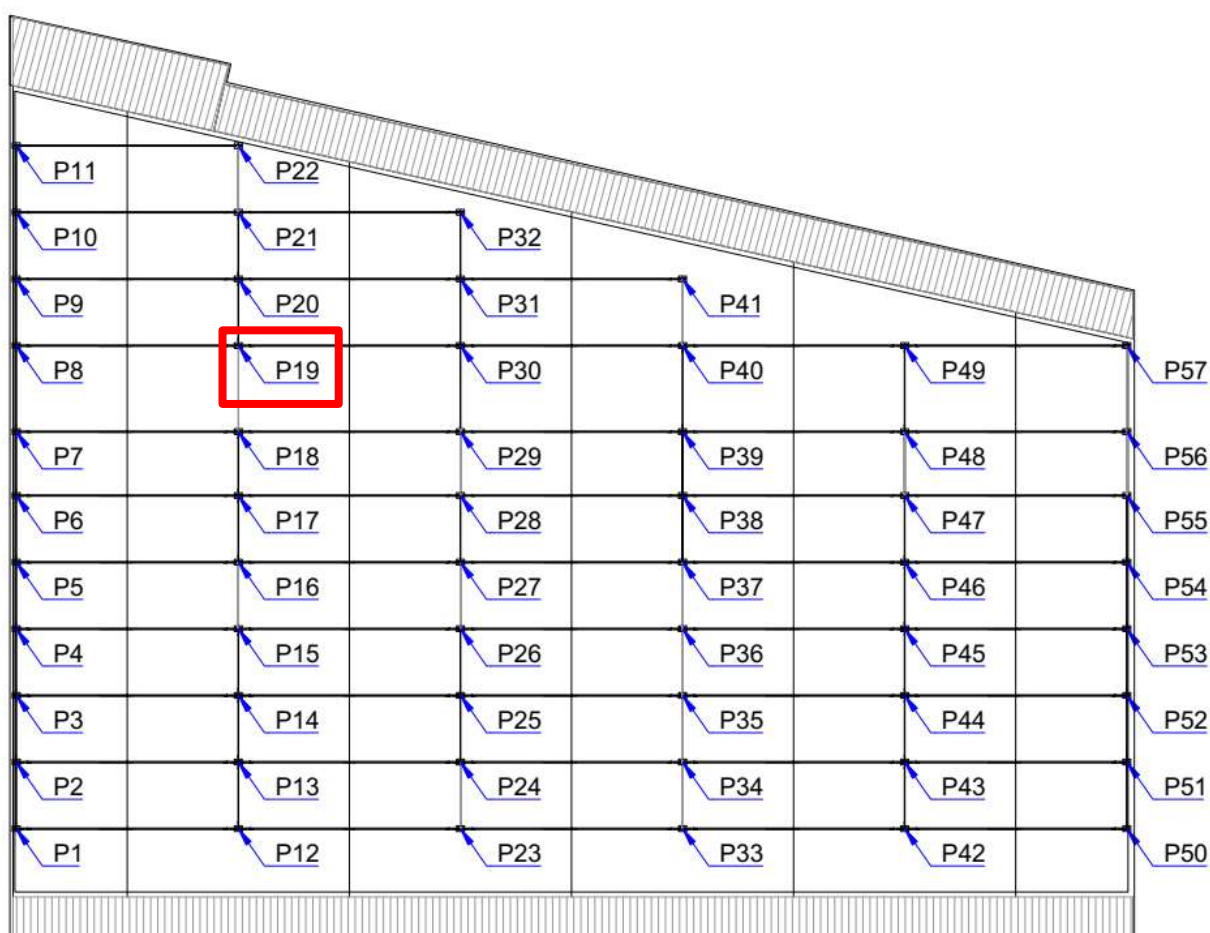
LOCALIZAÇÃO DO PILAR INSPECIONADO
